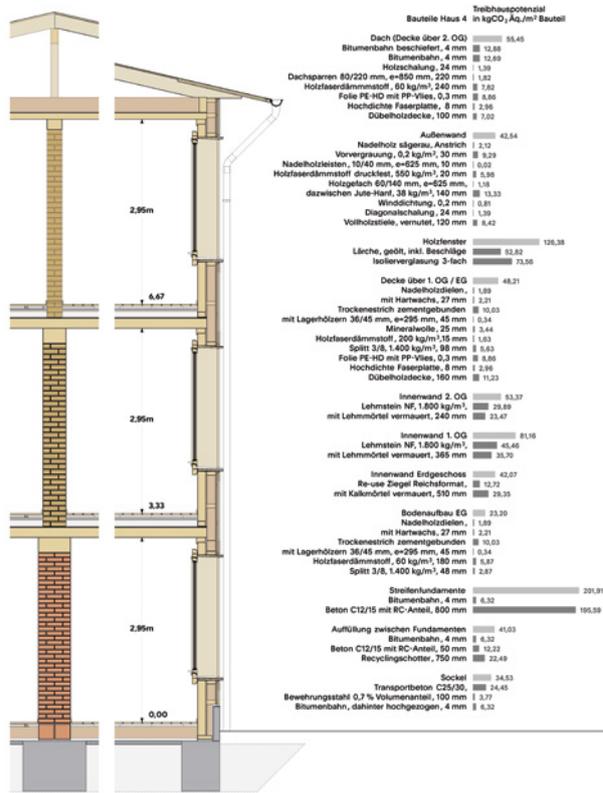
Haus 4: Detailschnitt und Treibhauspotential der Bauteile
